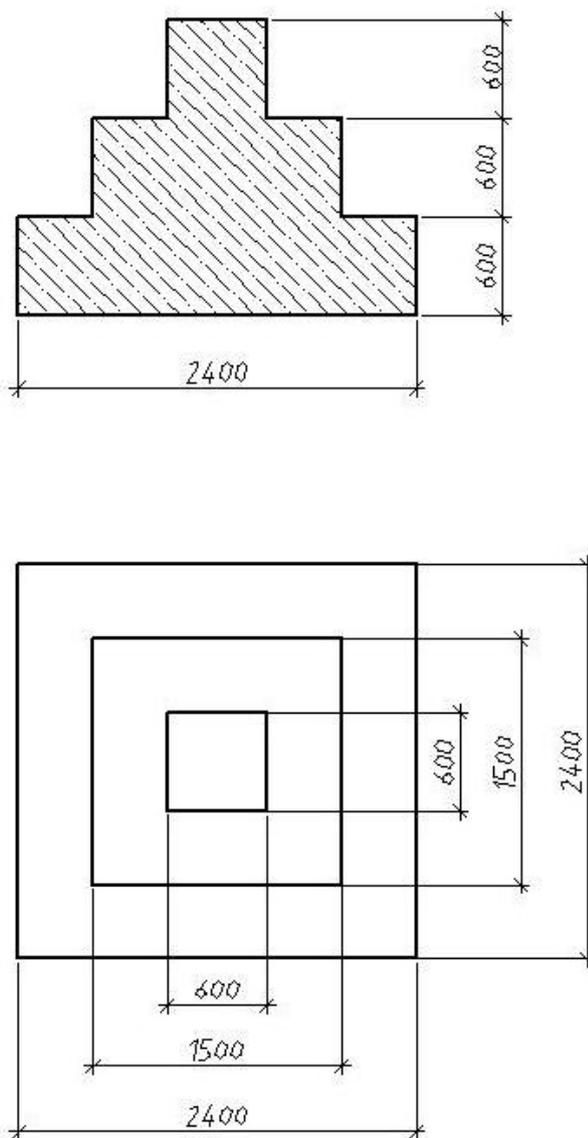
Схема фундамента мелкого заложения под колонну в осях К/6
